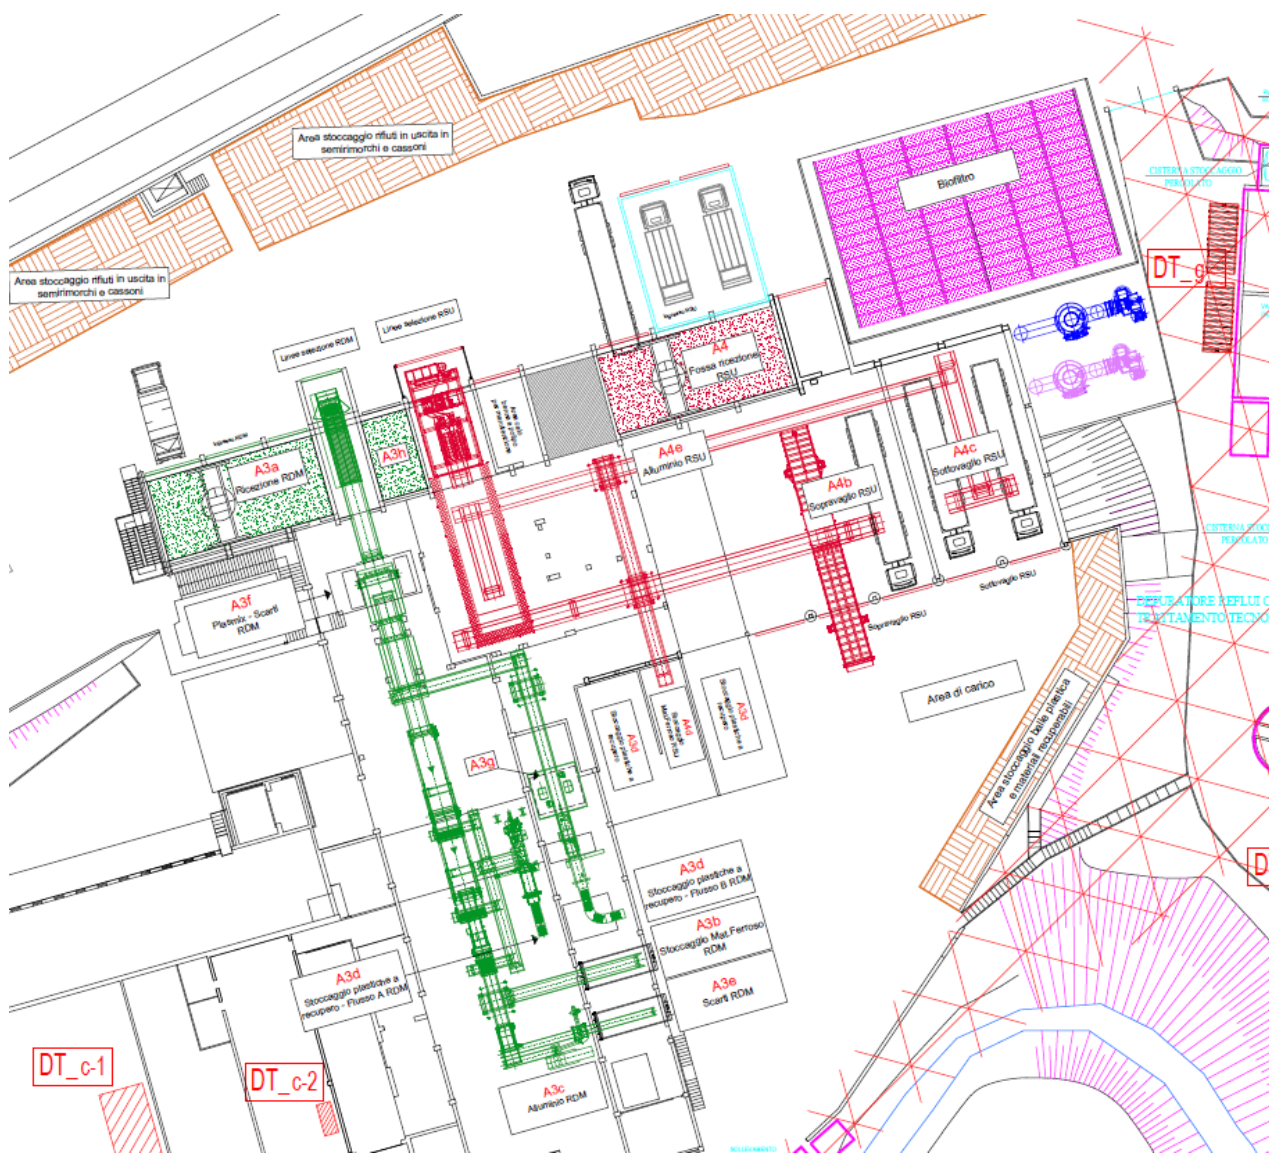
Estratto da Tavola V “Planimetria generale dell’impianto IPPC – Stato di progetto”.
